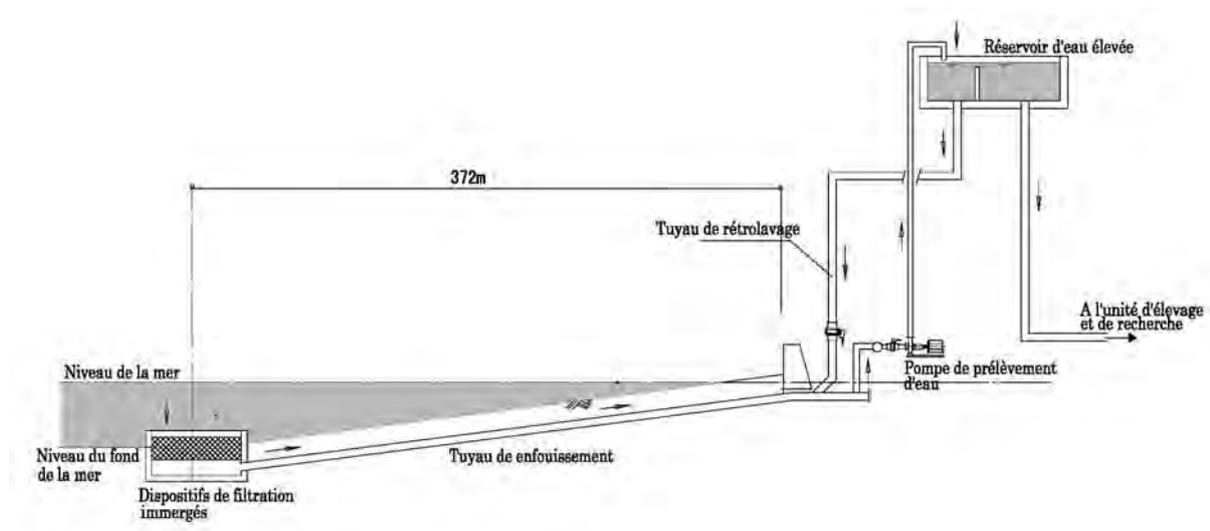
Schéma d'une installation à prélèvement à filtration immergée
